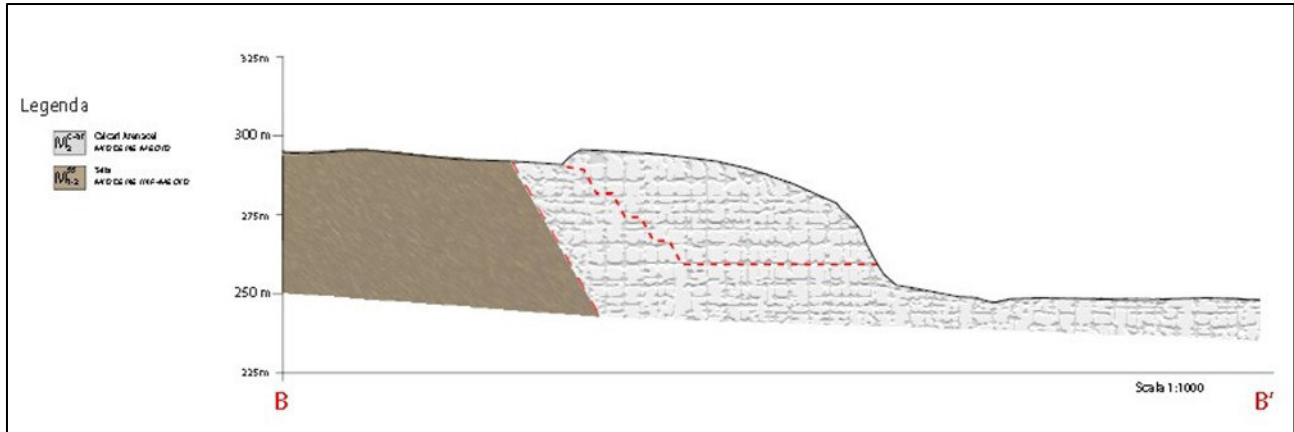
Sezione Geotecnica "Tipo" dell'Area di Cava
